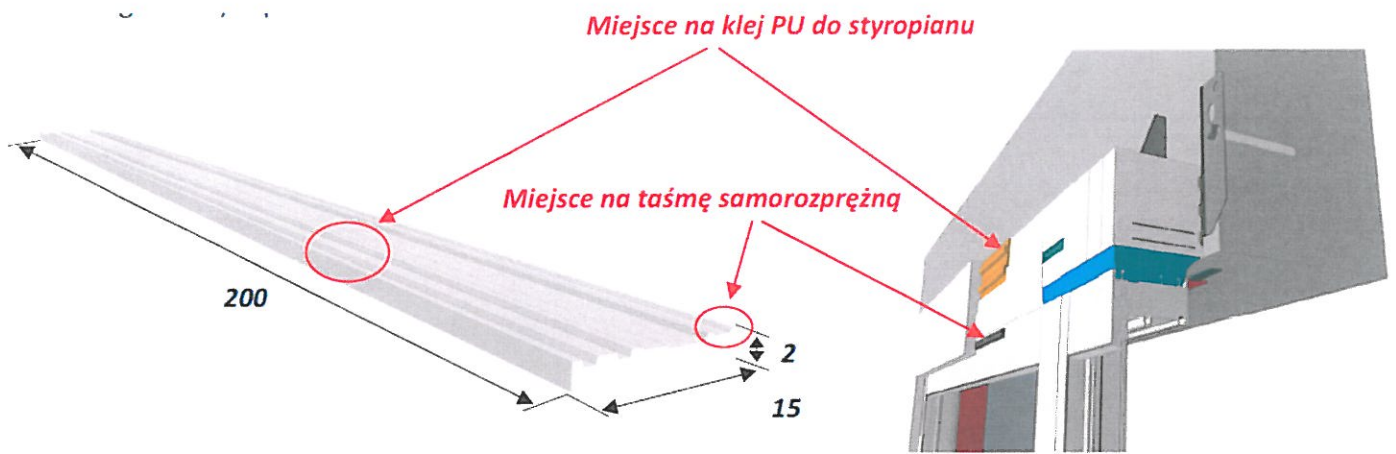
Podstawa Parapetu Zewnętrznego – (PPZ)
